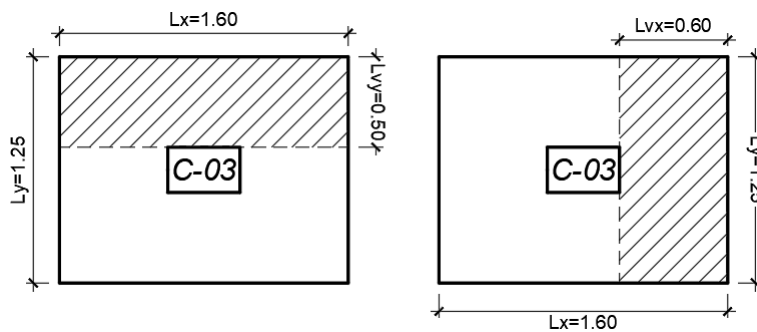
3. Áreas en voladizo en la zapata Z-03
